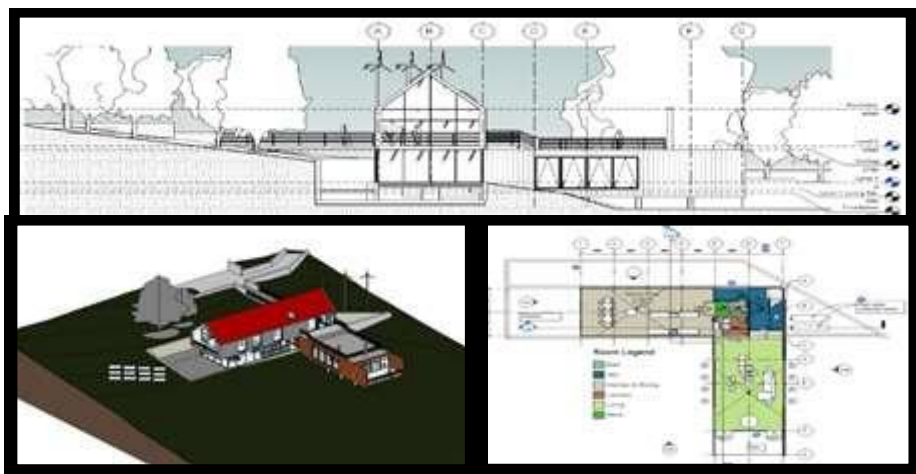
Vista 3D, Plano, y Fachada del Proyecto ejemplo Revit 2019
